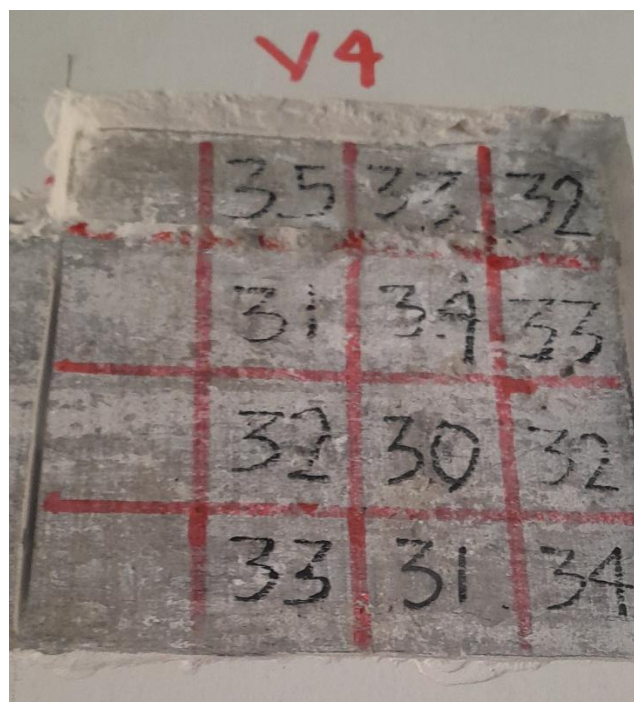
Realizando el ensayo de esclerometría en una de las columnas del primer nivel.
